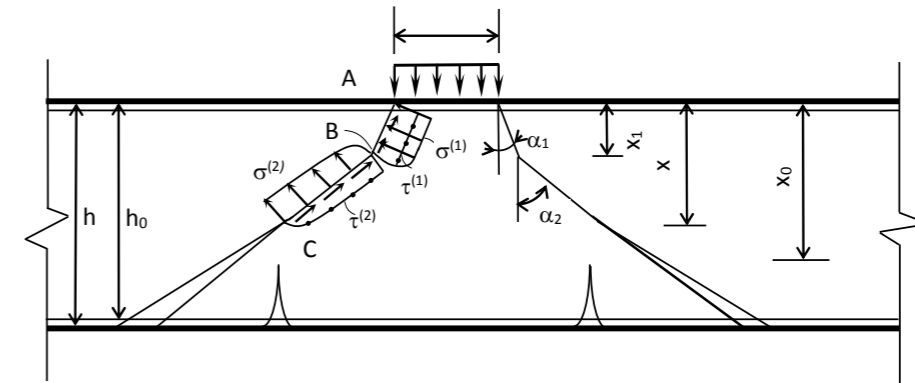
Расчетная схема железобетонных плит при действии локальных нагрузок
